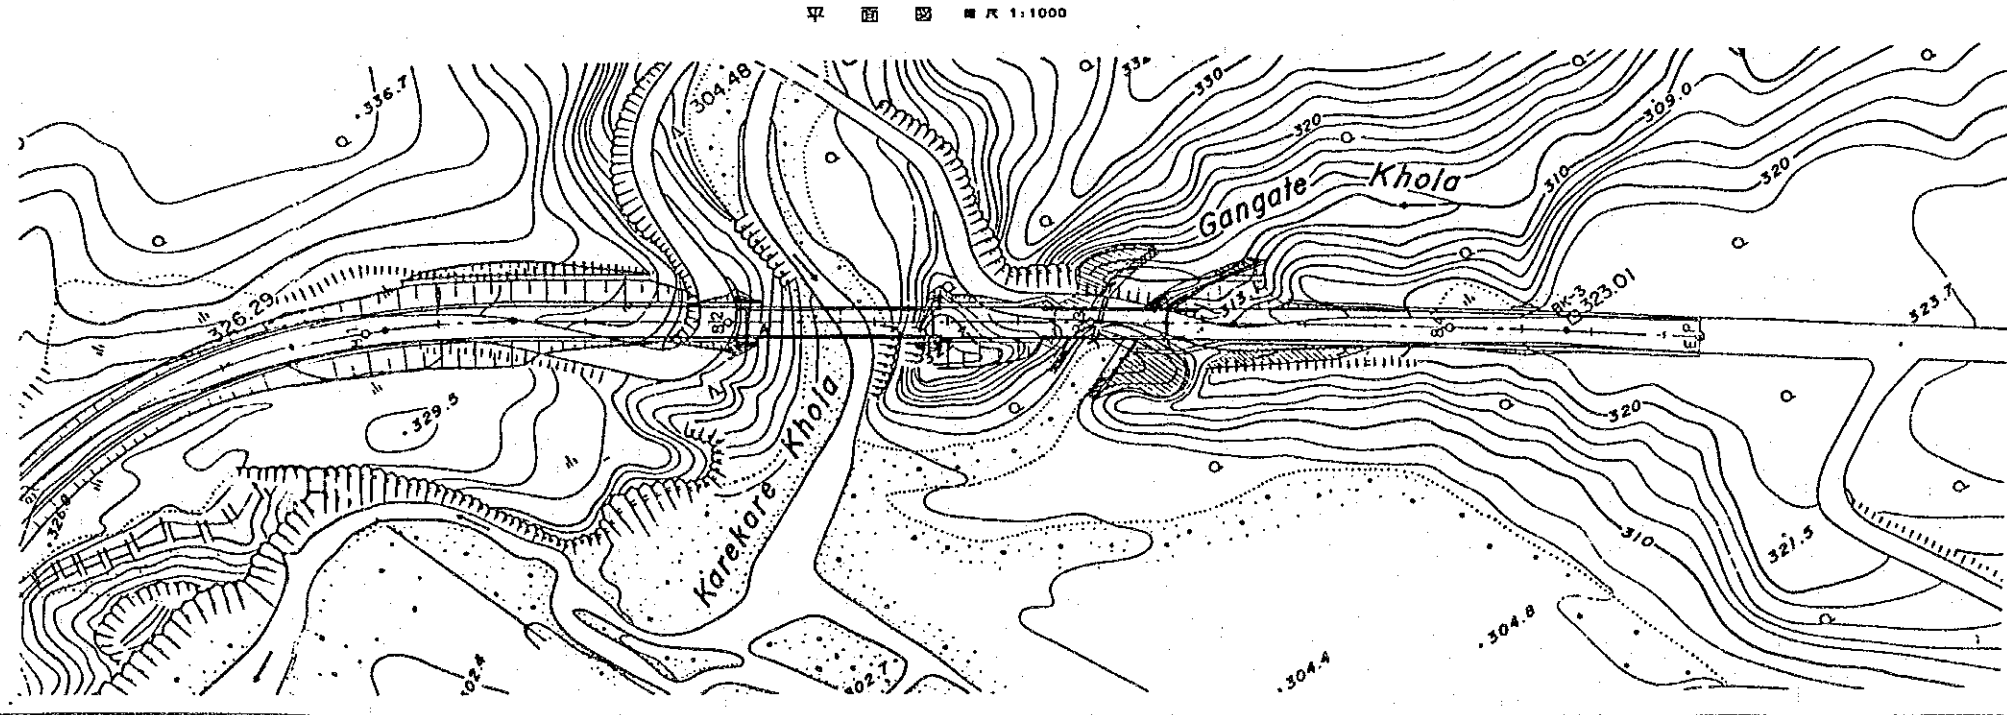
ボガテ(Bhogate)橋取付道路平面・断面標準横断面図
